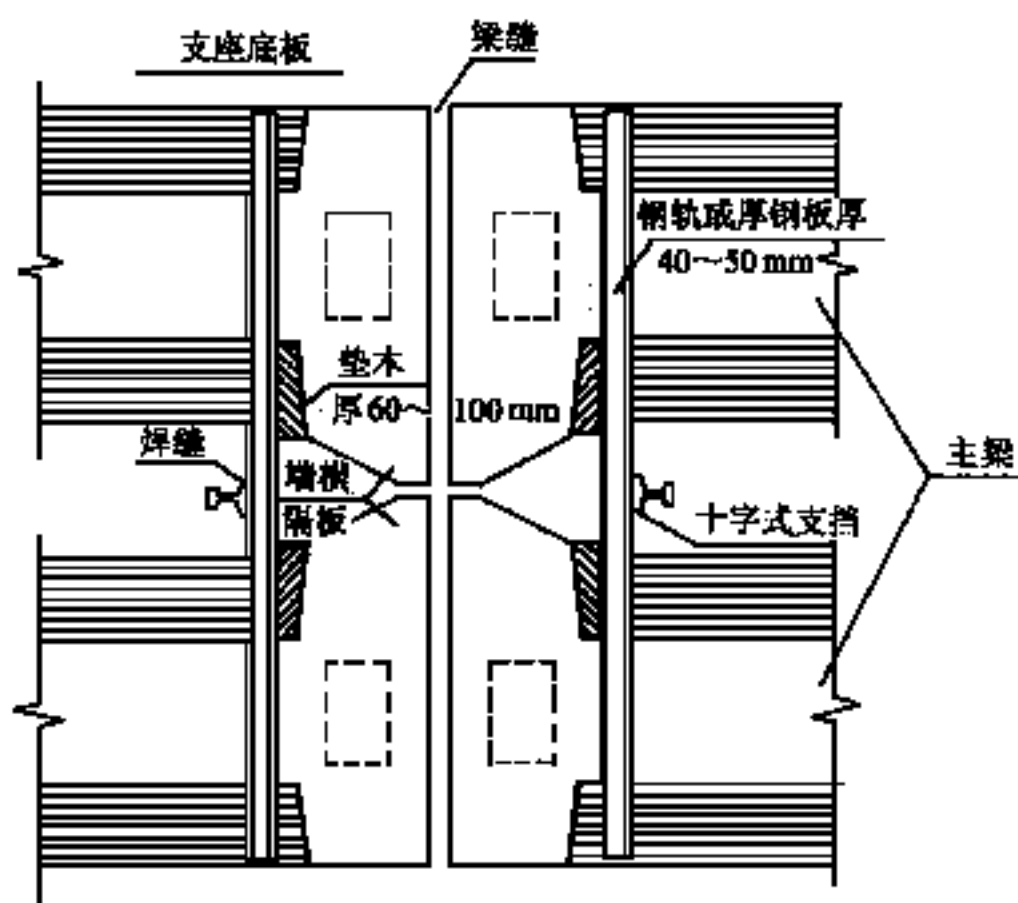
低高度钢筋混凝土梁纵向支挡布置
